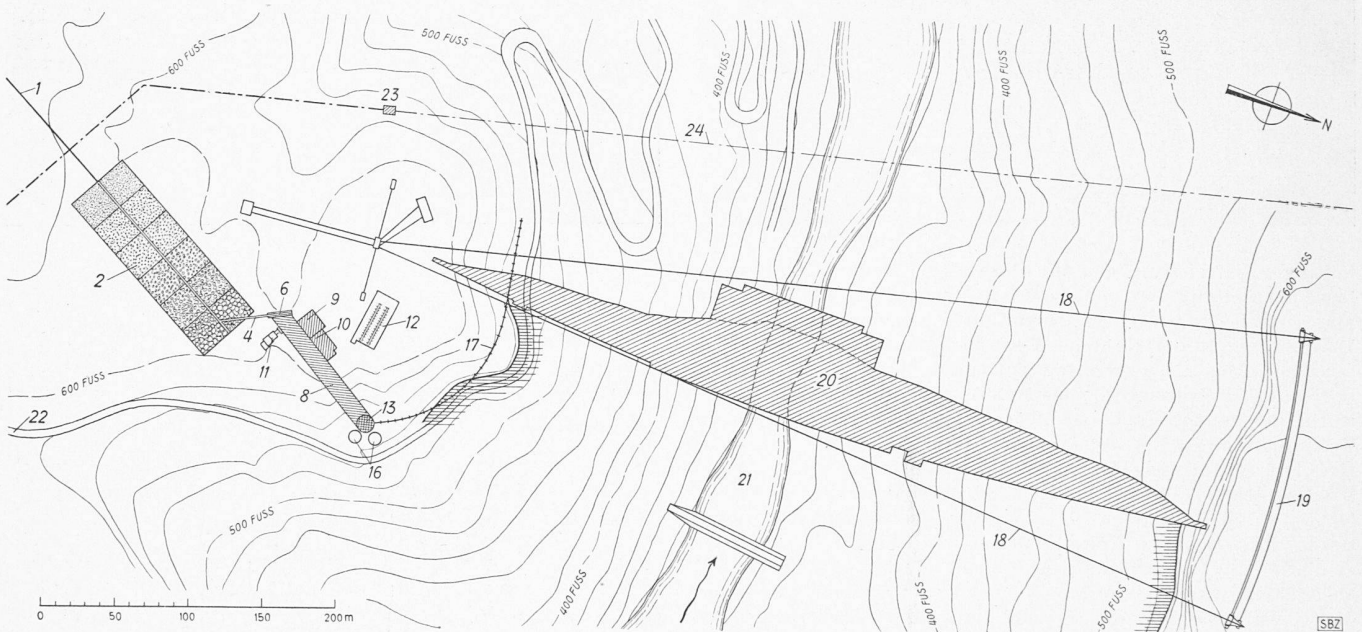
Lageplan der Vaitarna-Staumauer mit Bauplatz-Organisation, Masstab 1:5000
